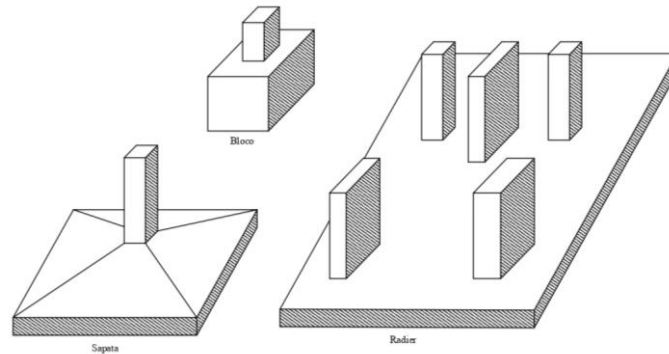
Tipos de fundações superficiais (Fonte: Próprio autor).
